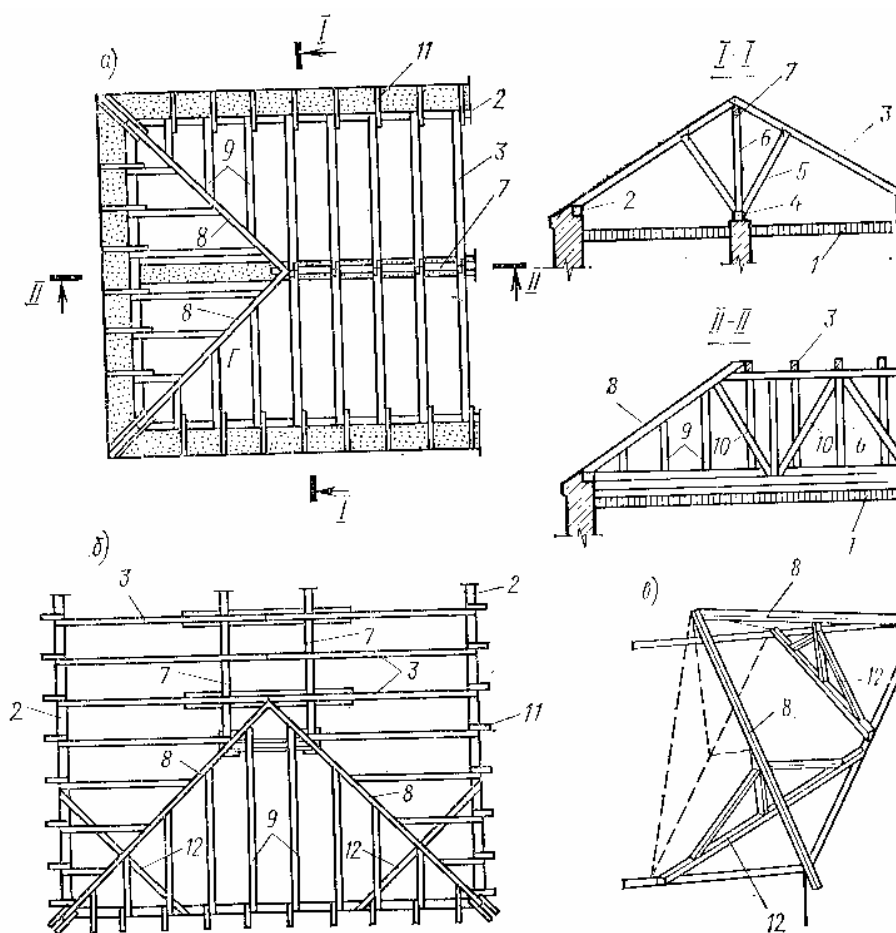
Расположение в плане наслонных стропил в зданиях:
